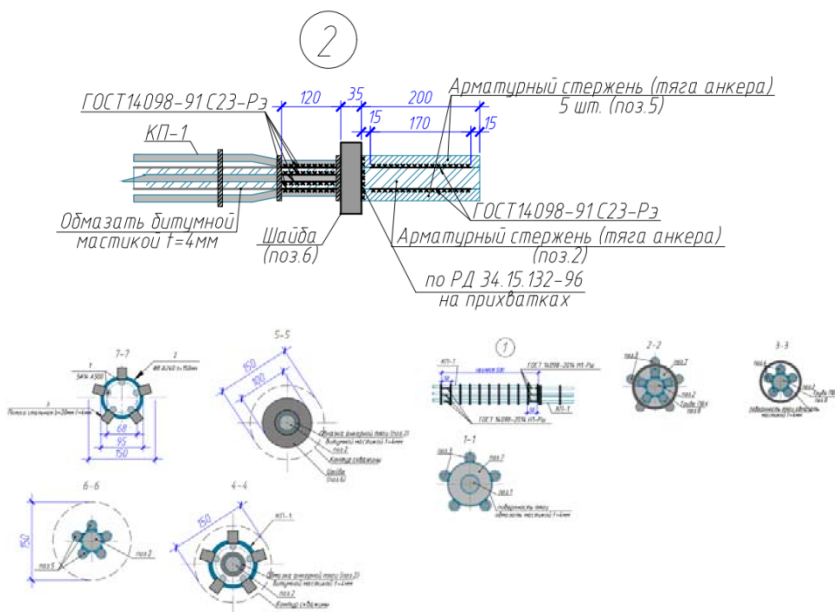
Арматурный каркас грунтового анкера ЭРТ
